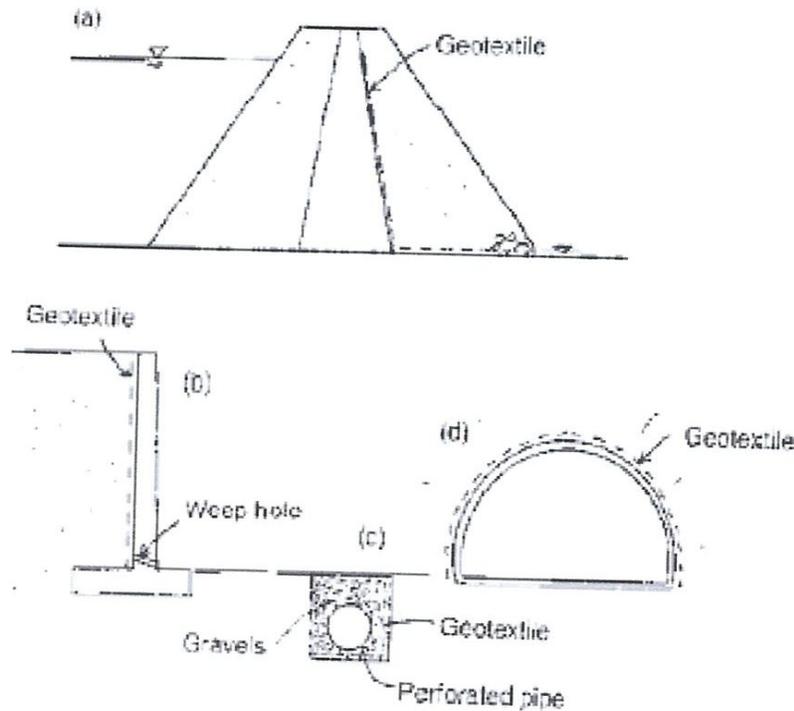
Géotextile comme couche drainante ou filtrante (a) drain cheminée dans un sol mou ; (b) drain maintenant la dernière d'un mur ; (c) drainage souterrain ; (d) couche de drainage dans un tunnel.
